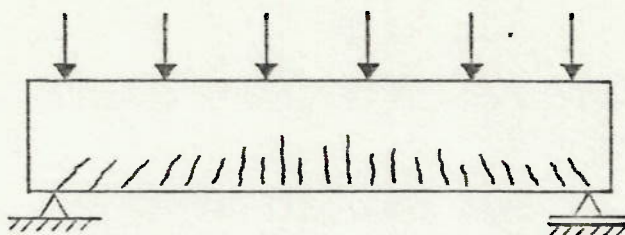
Fissuração típica em viga sub-armada solicitada à flexão
